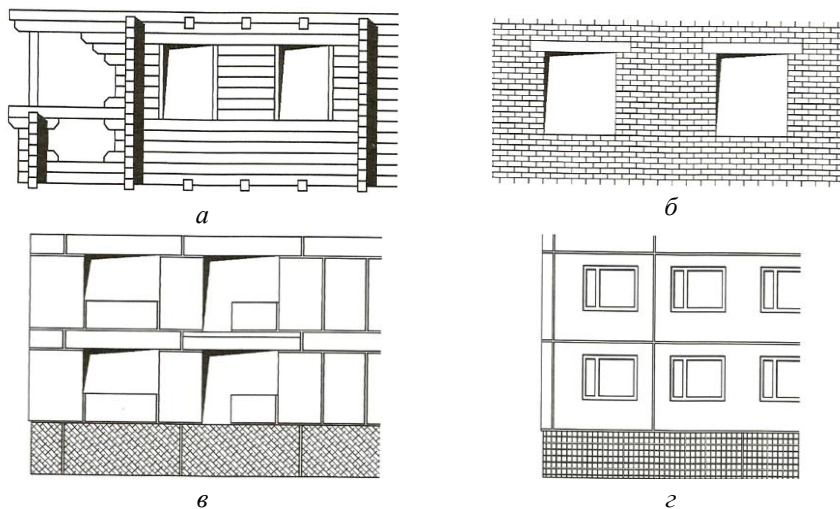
Примеры строительных систем (фрагменты фасадов зданий):
